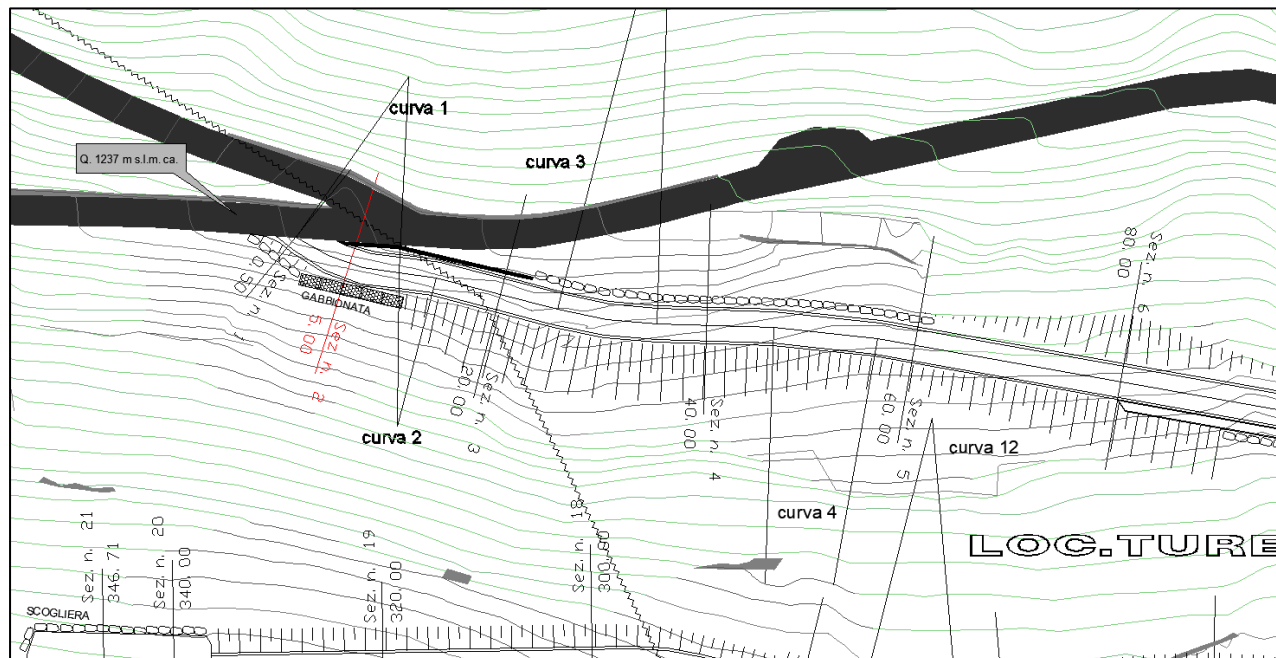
Loc. Turel - SEZ. 2 - UBICAZIONE TRACCIA SEZIONE DI CALCOLO GEOTECNICO
